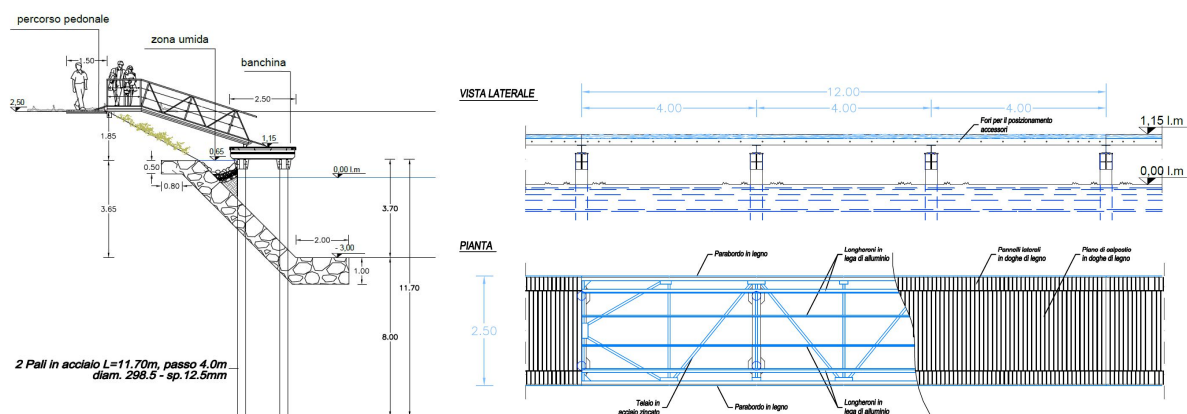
Sezione, pianta e vista laterale delle banchine per ormeggi
